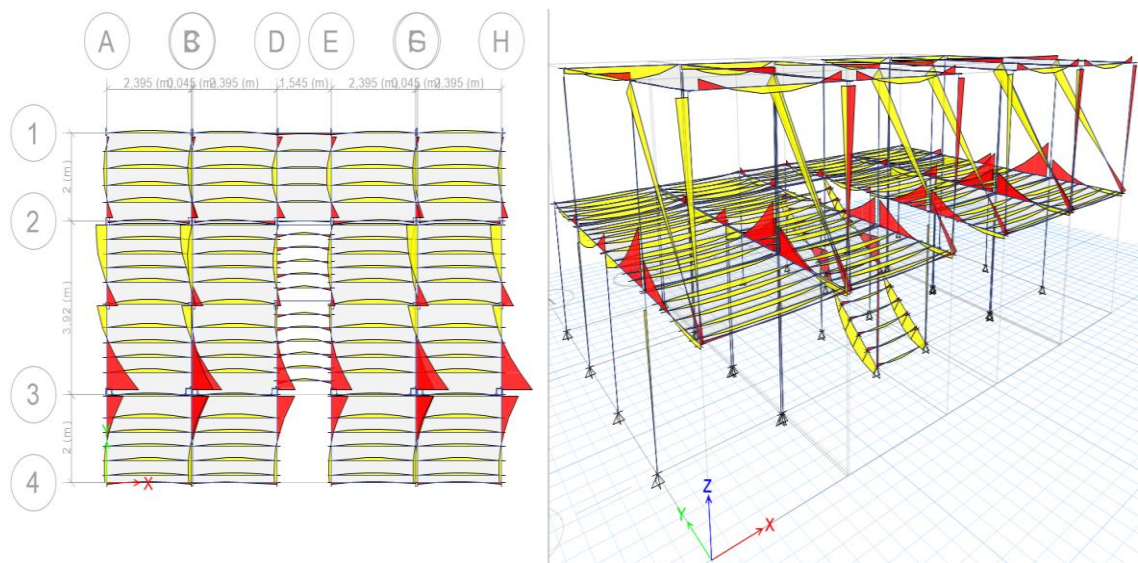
Diagrama de momentos. Vista en planta y perspectiva
